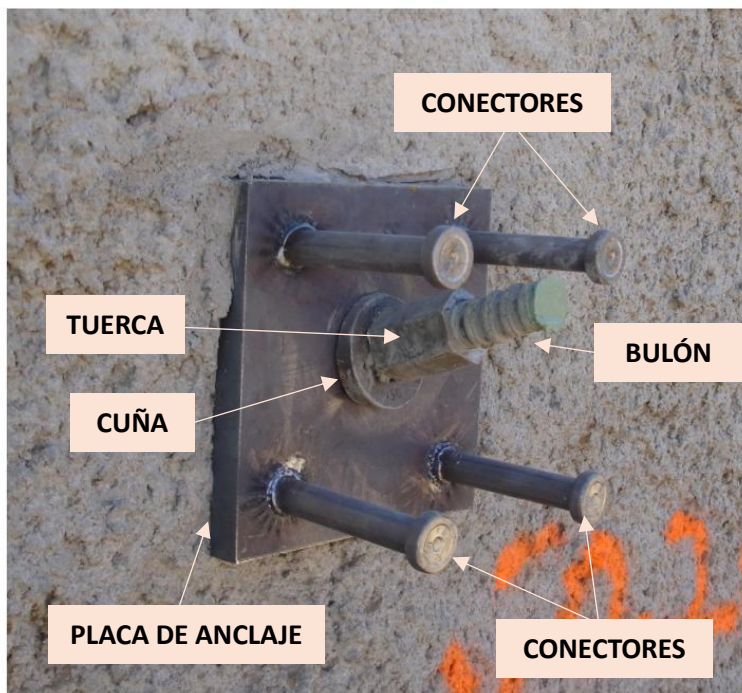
Imagen de la cabeza de un bulón en el que se aprecian la placa de anclaje, la cuña, la tuerca y los pernos conectores preparados para el revestimiento exterior (Fuente: Soil Nail Walls – Reference Manual (FHWA, 2015))
